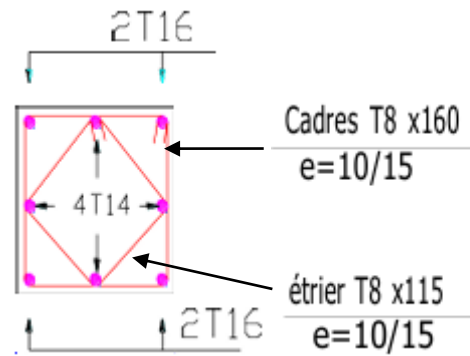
Schémas de ferrailage des poteaux.
